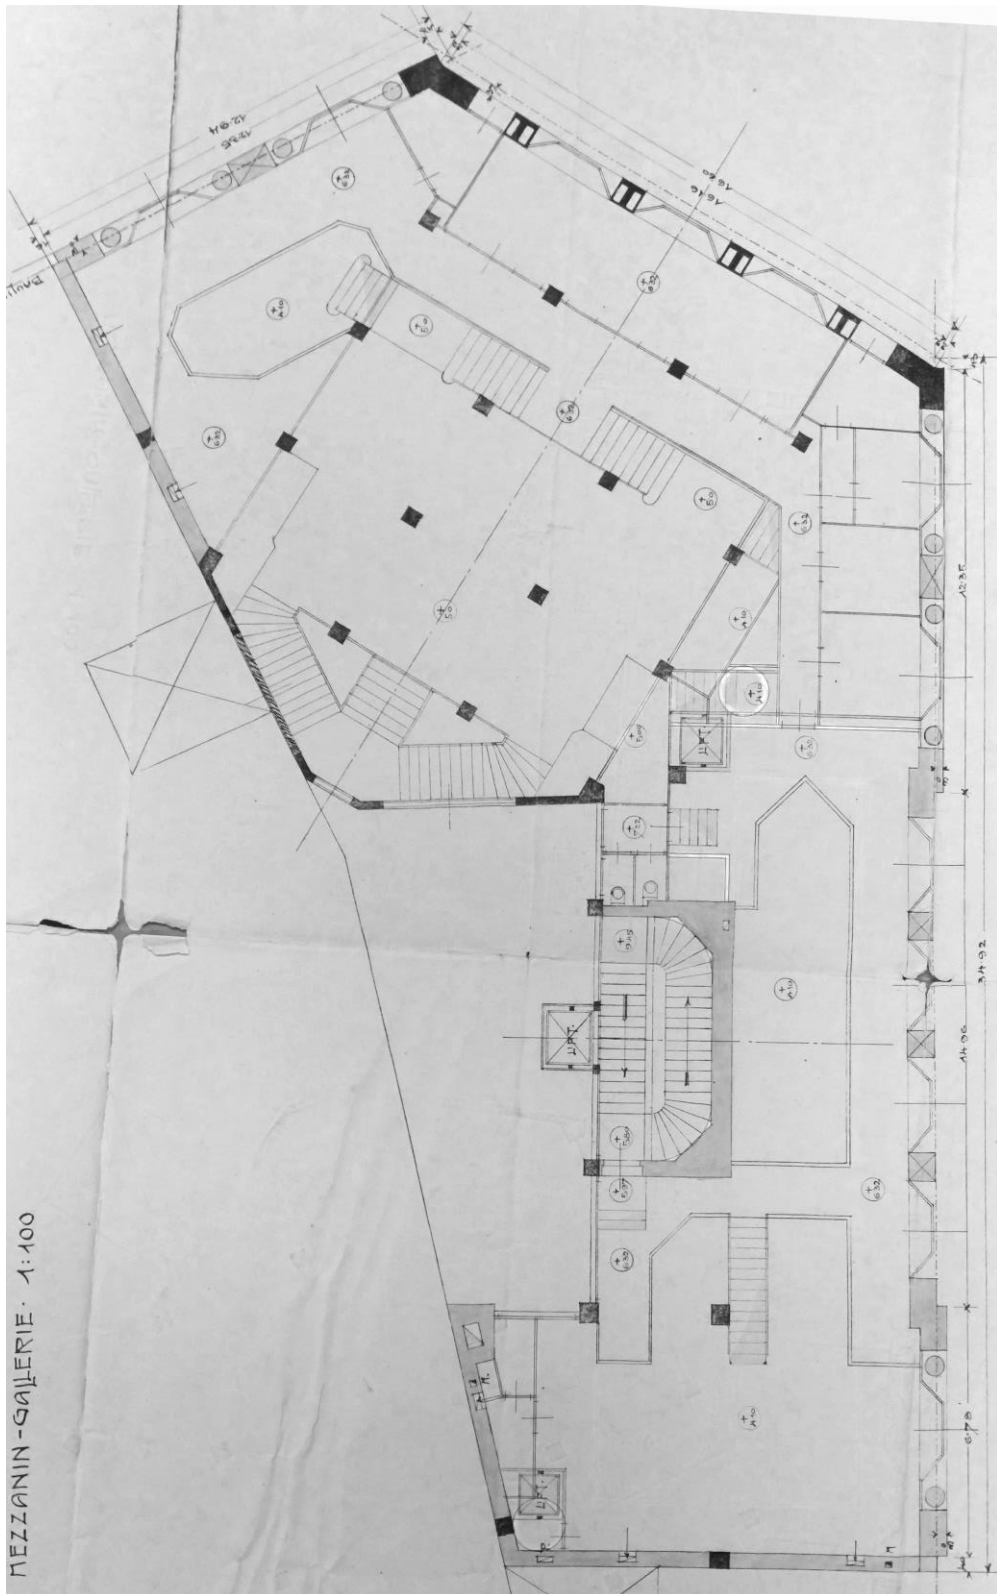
Adolf Loos, Warenhaus Goldman&Salatsch, Grundriss Mezzanin, Michaelerplatz, 1911
